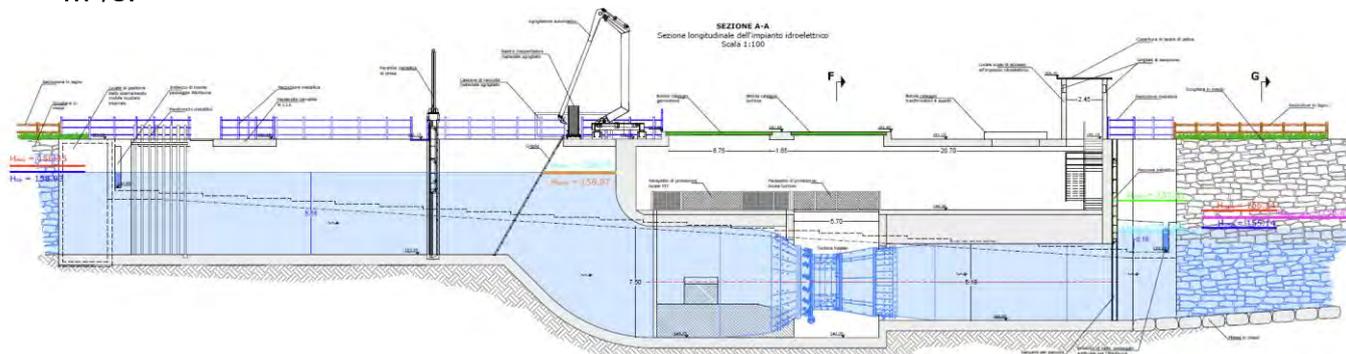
Sezione longitudinale turbina Kaplan "PIT"
